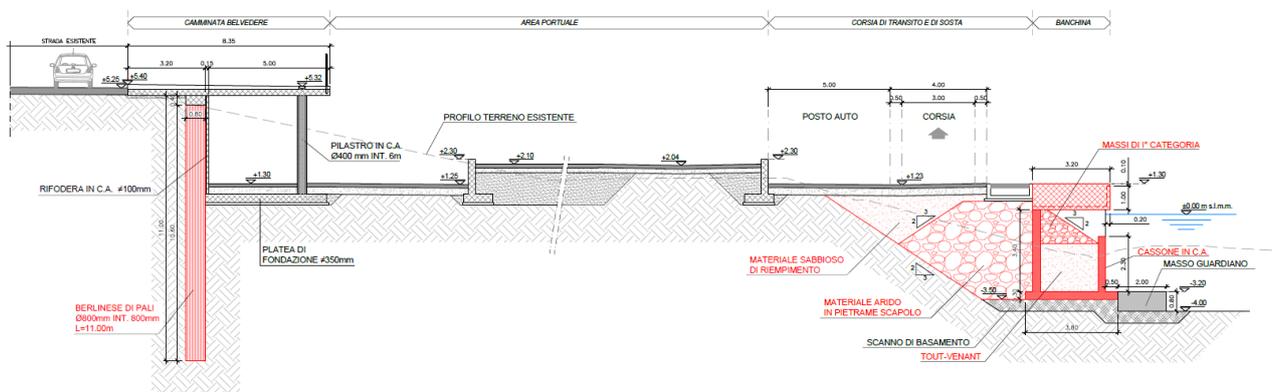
Sezione di progetto su circolo nautico – collegamento con viabilità esistente.
